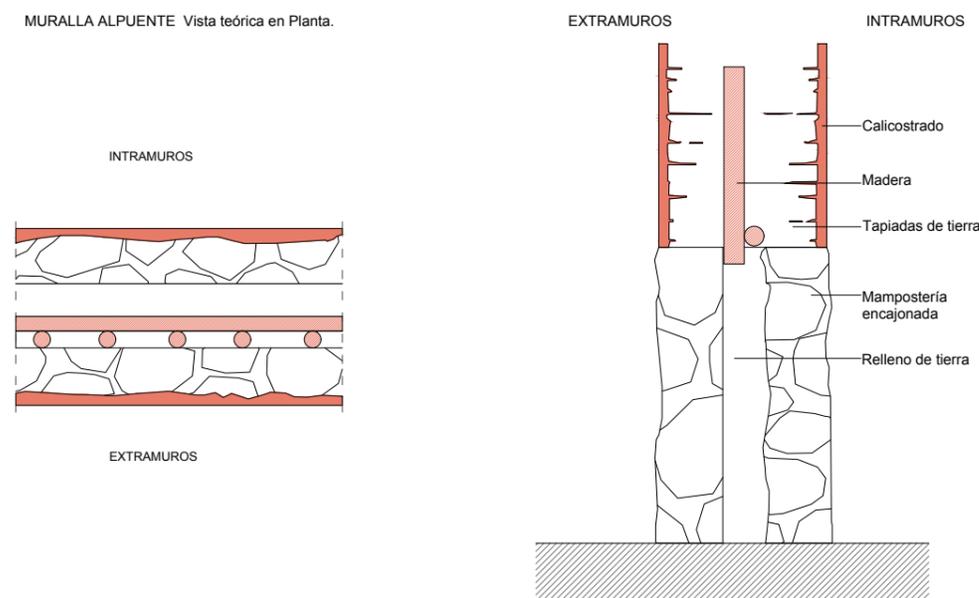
b. Detalle muralla Alpuente, vista teórica de planta y sección. Esc. 1:30 (F. Cotino, 2007)
